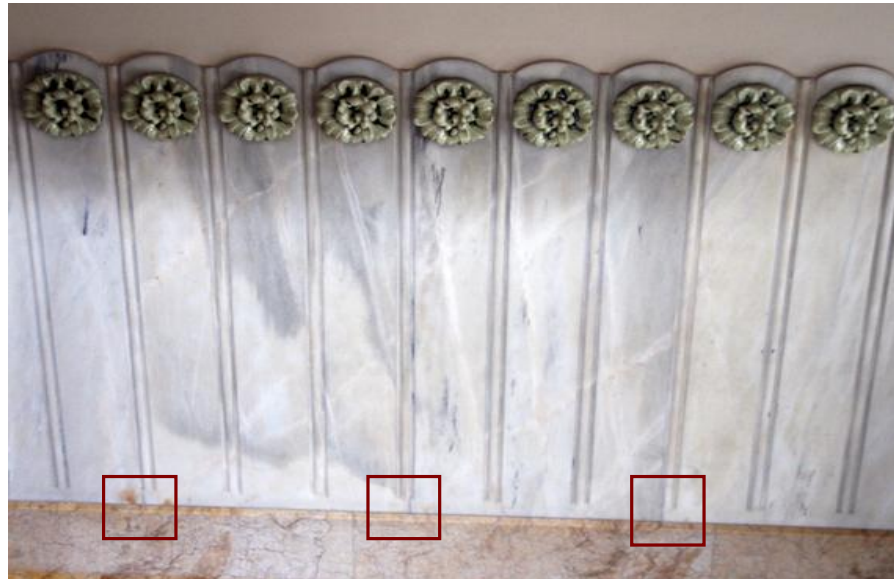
Alzado y planta de zócalo. Zona de acceso al torreón izquierdo. (A. Propio 2011).
